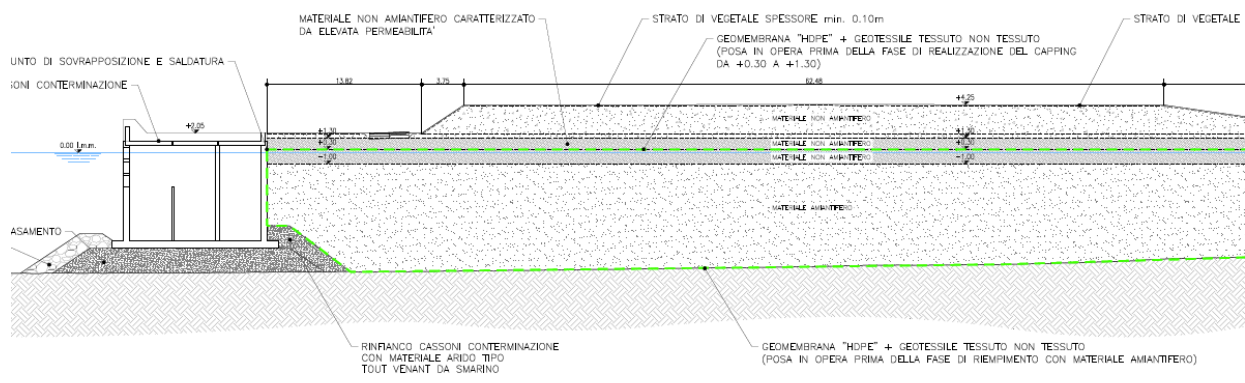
Stralcio di sezione raffigurante gli strati della colmata
